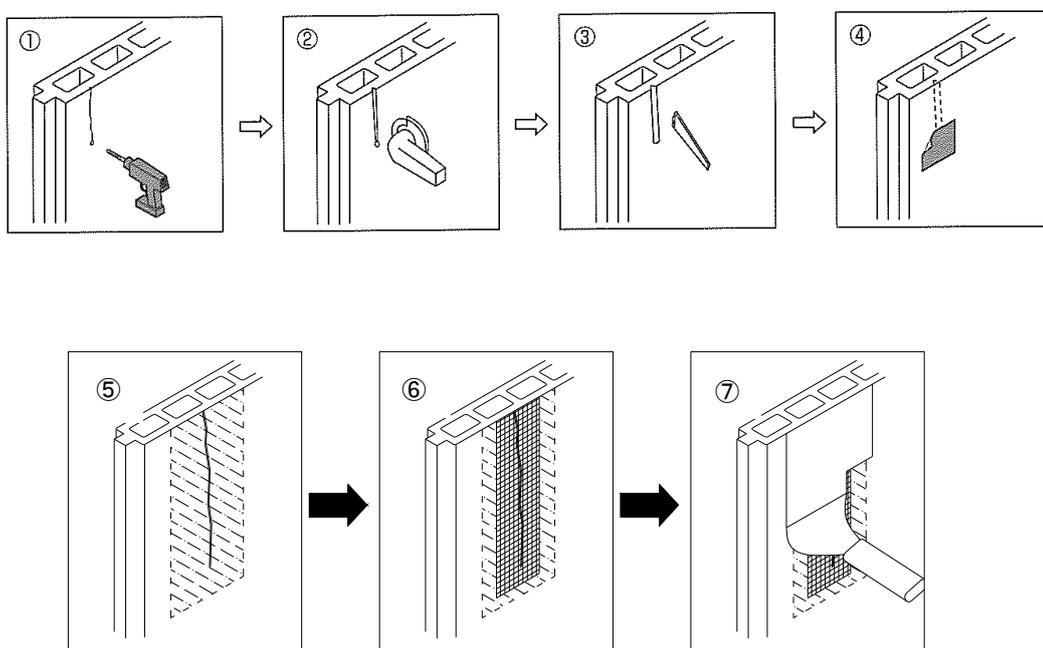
押出成形セメント板のひび割れ補修（Uカット補修方法）
